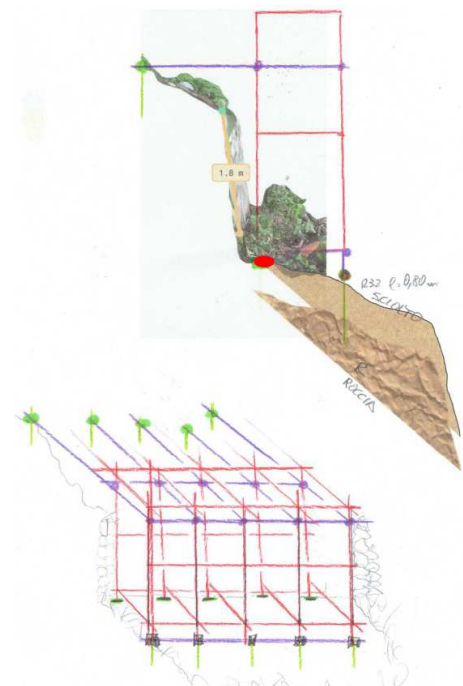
Sezione tipo con ponteggio di tipo B
